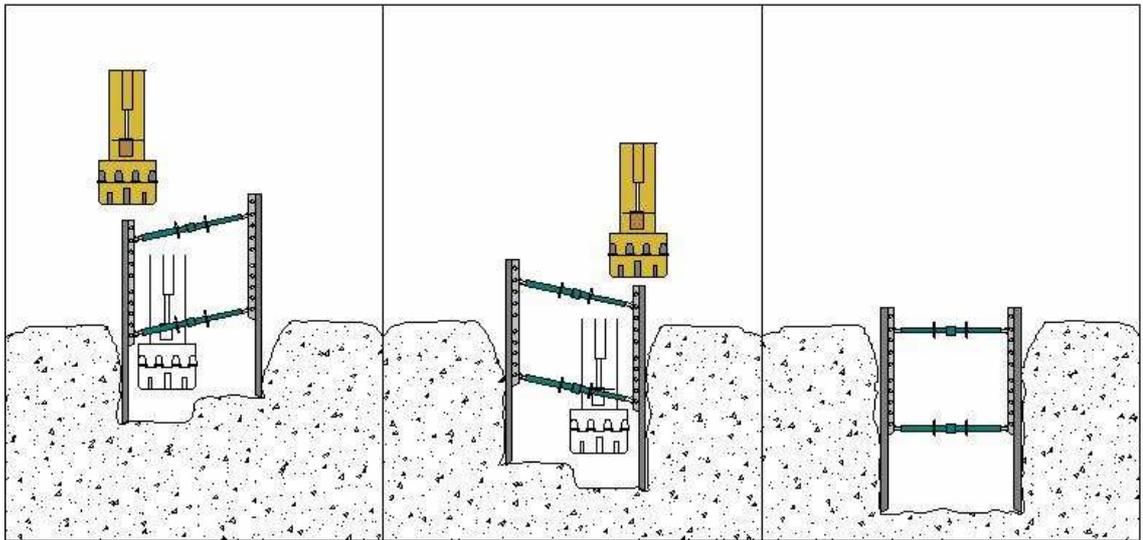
Colocación final del modulo del Sistema de Cajón./Elaboración Propia.
